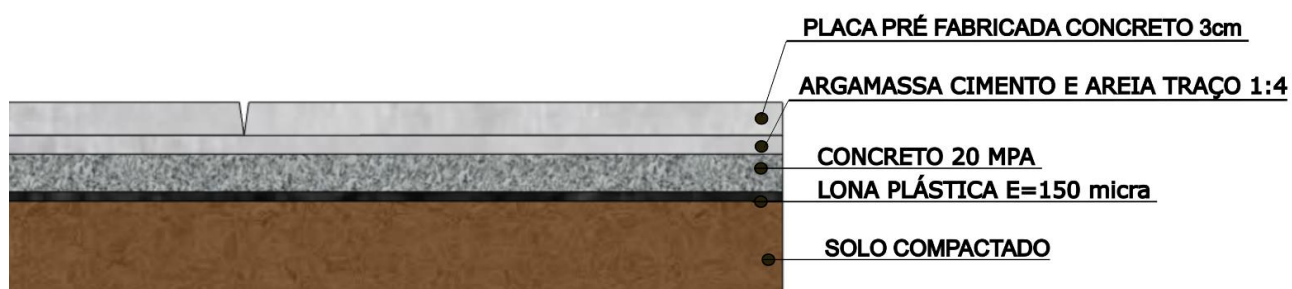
Passeio com piso em placa pré-fabricada. Fonte: Elaboração própria.
